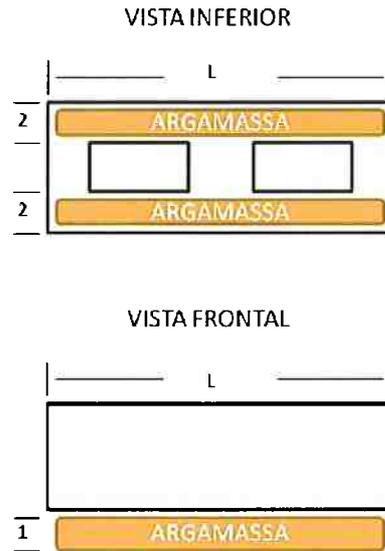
Colocação da junta horizontal no bloco de alvenaria estrutural
